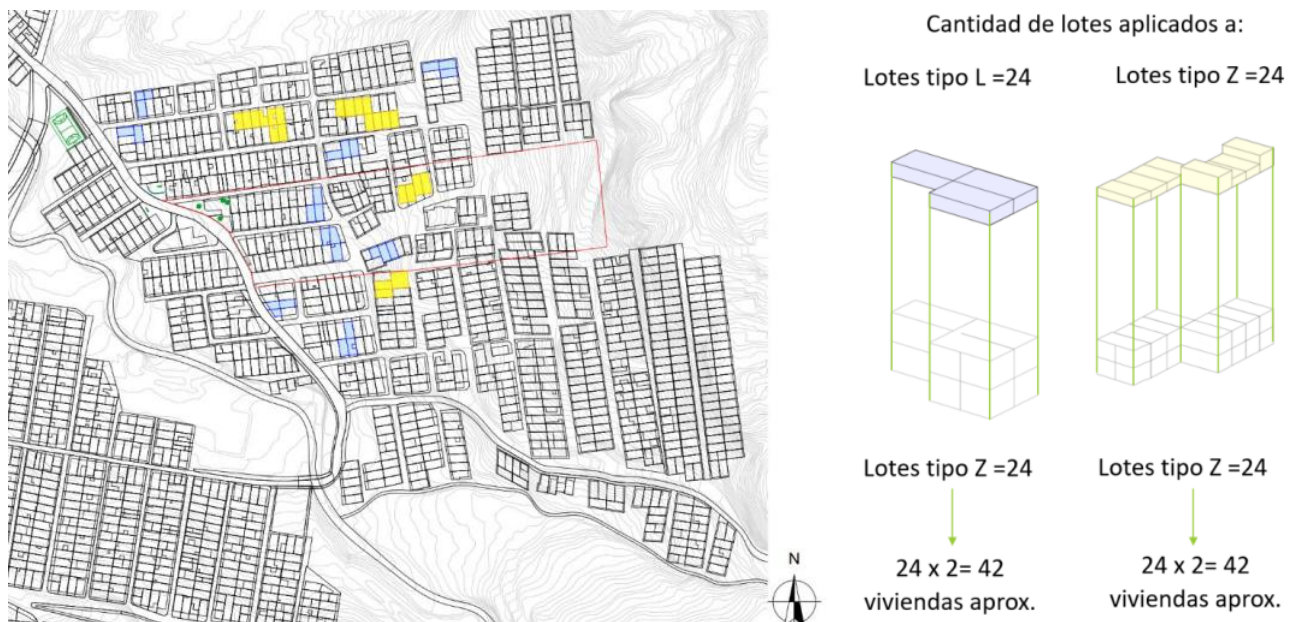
Tipologías de vivienda + cantidad de viviendas propuestas Fuente: Elaboración Propia.
